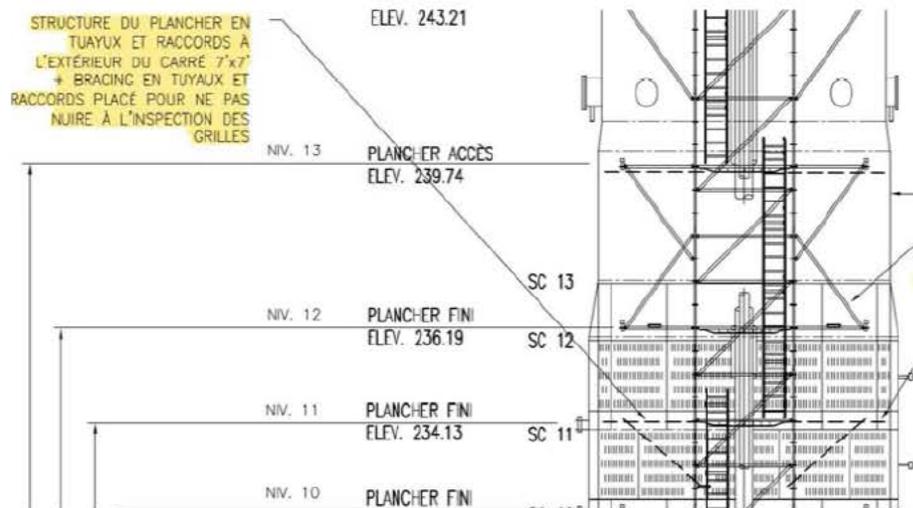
Extrait des plans, plancher en saillie (ass. tuyaux et raccords)
